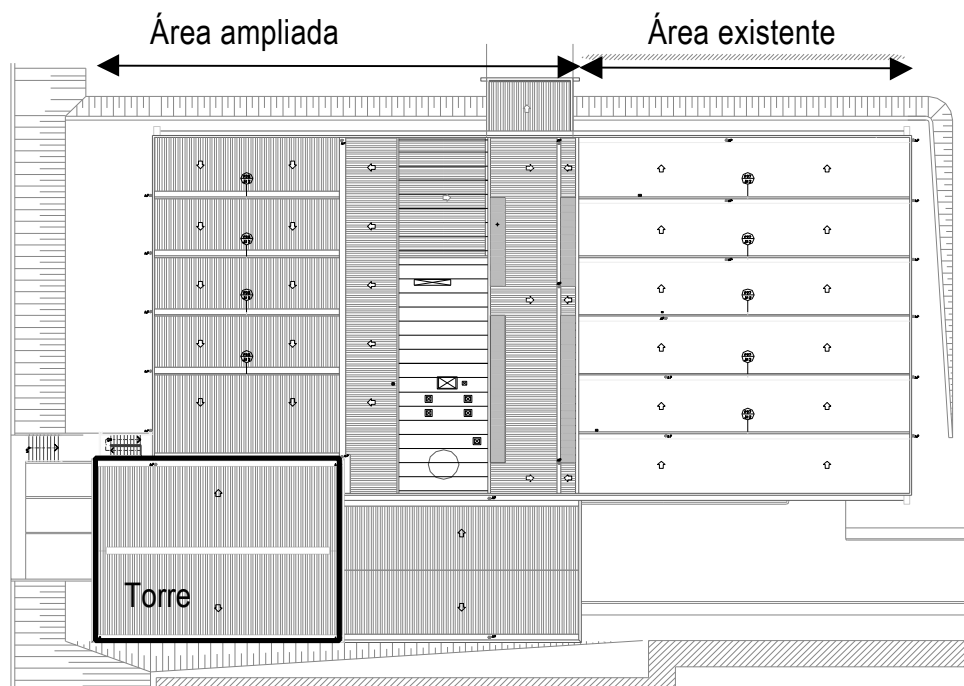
Planta de implantação do Laboratório Poly (s/ escala)
